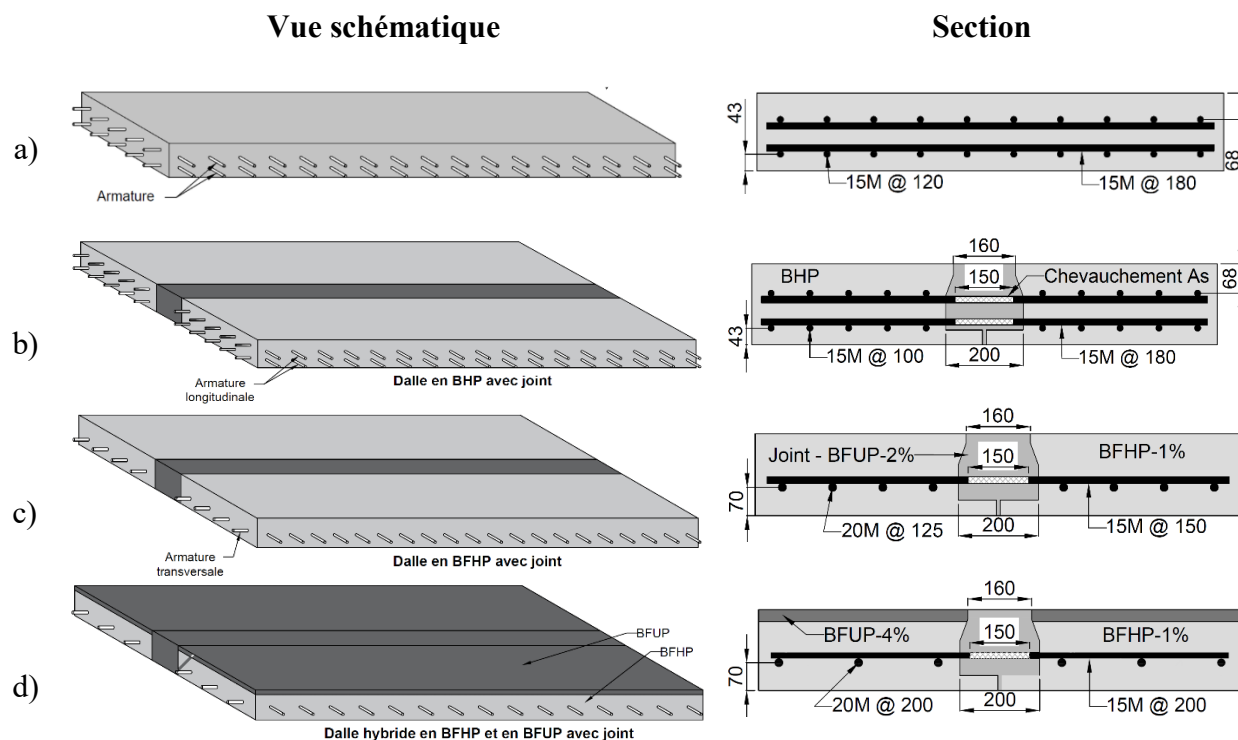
Spécimen du programme principal, a) Dalle de référence en BHP, b) Dalle en BHP avec joint, c) Dalle en BFHP avec joint, d) Dalle hybride avec joint
